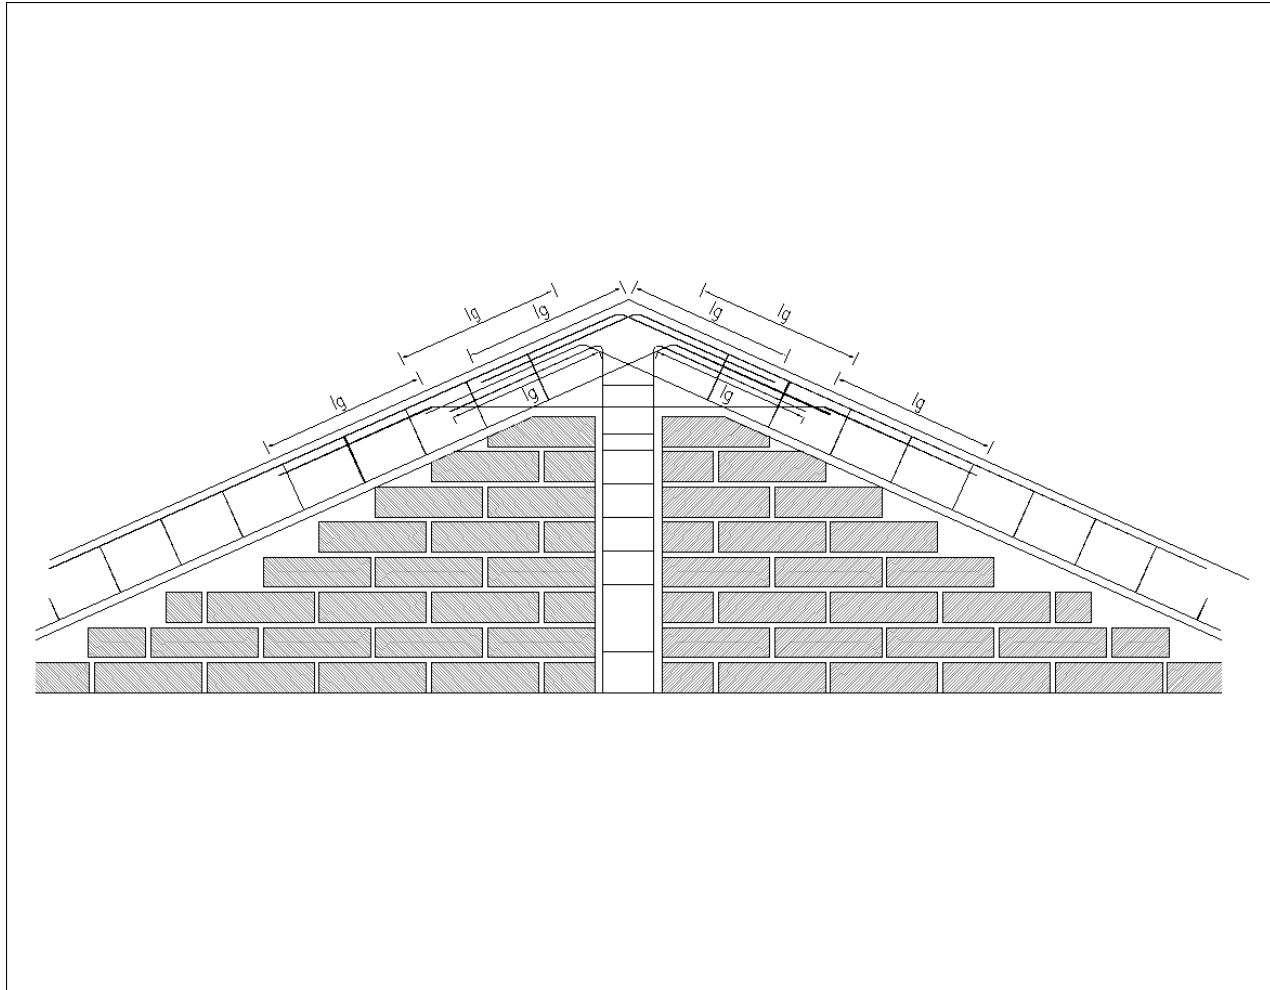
Detalle de refuerzos de un tímpano de albañilería
